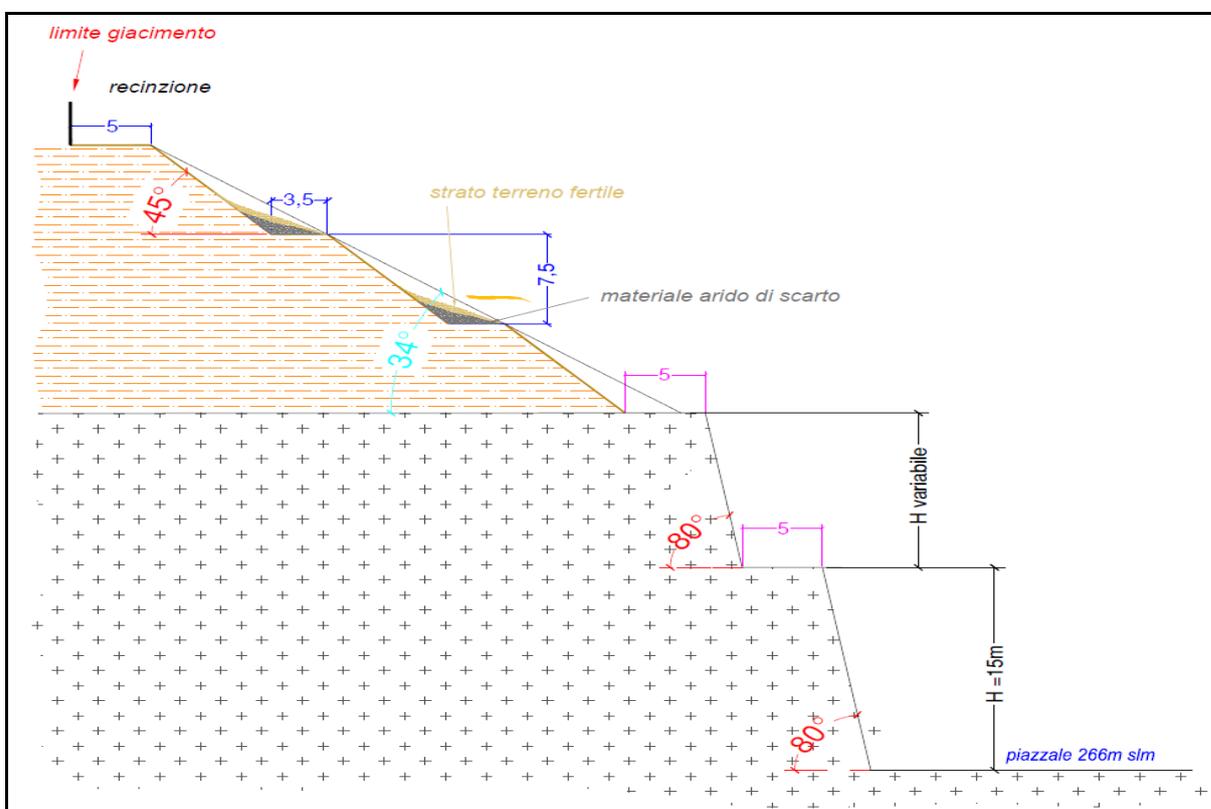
Stralcio Tav.17 progetto preliminare - sezione tipo di coltivazione
